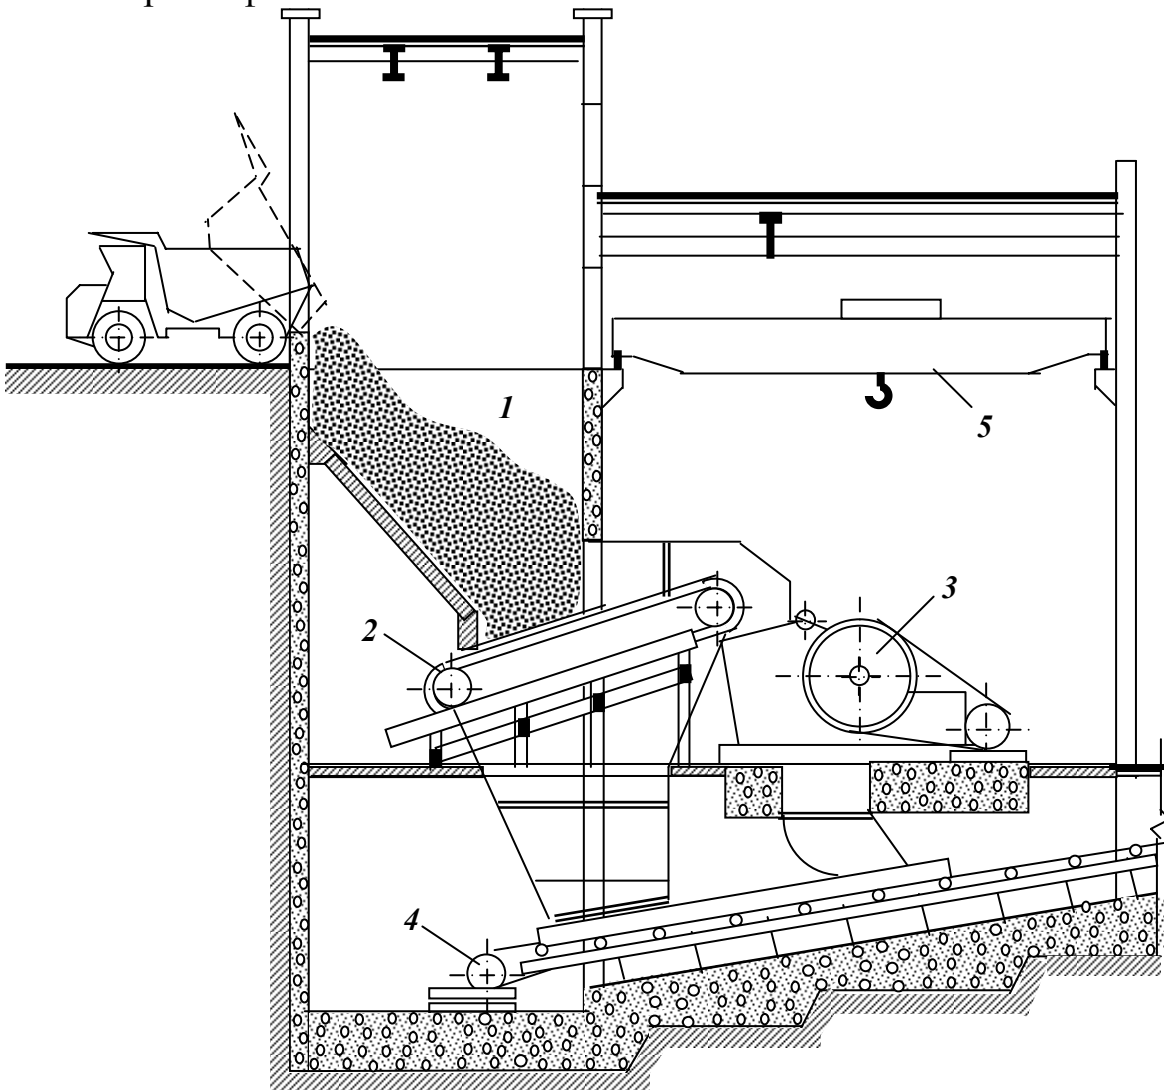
Корпус крупного дроблення з шоквою дробаркою.
